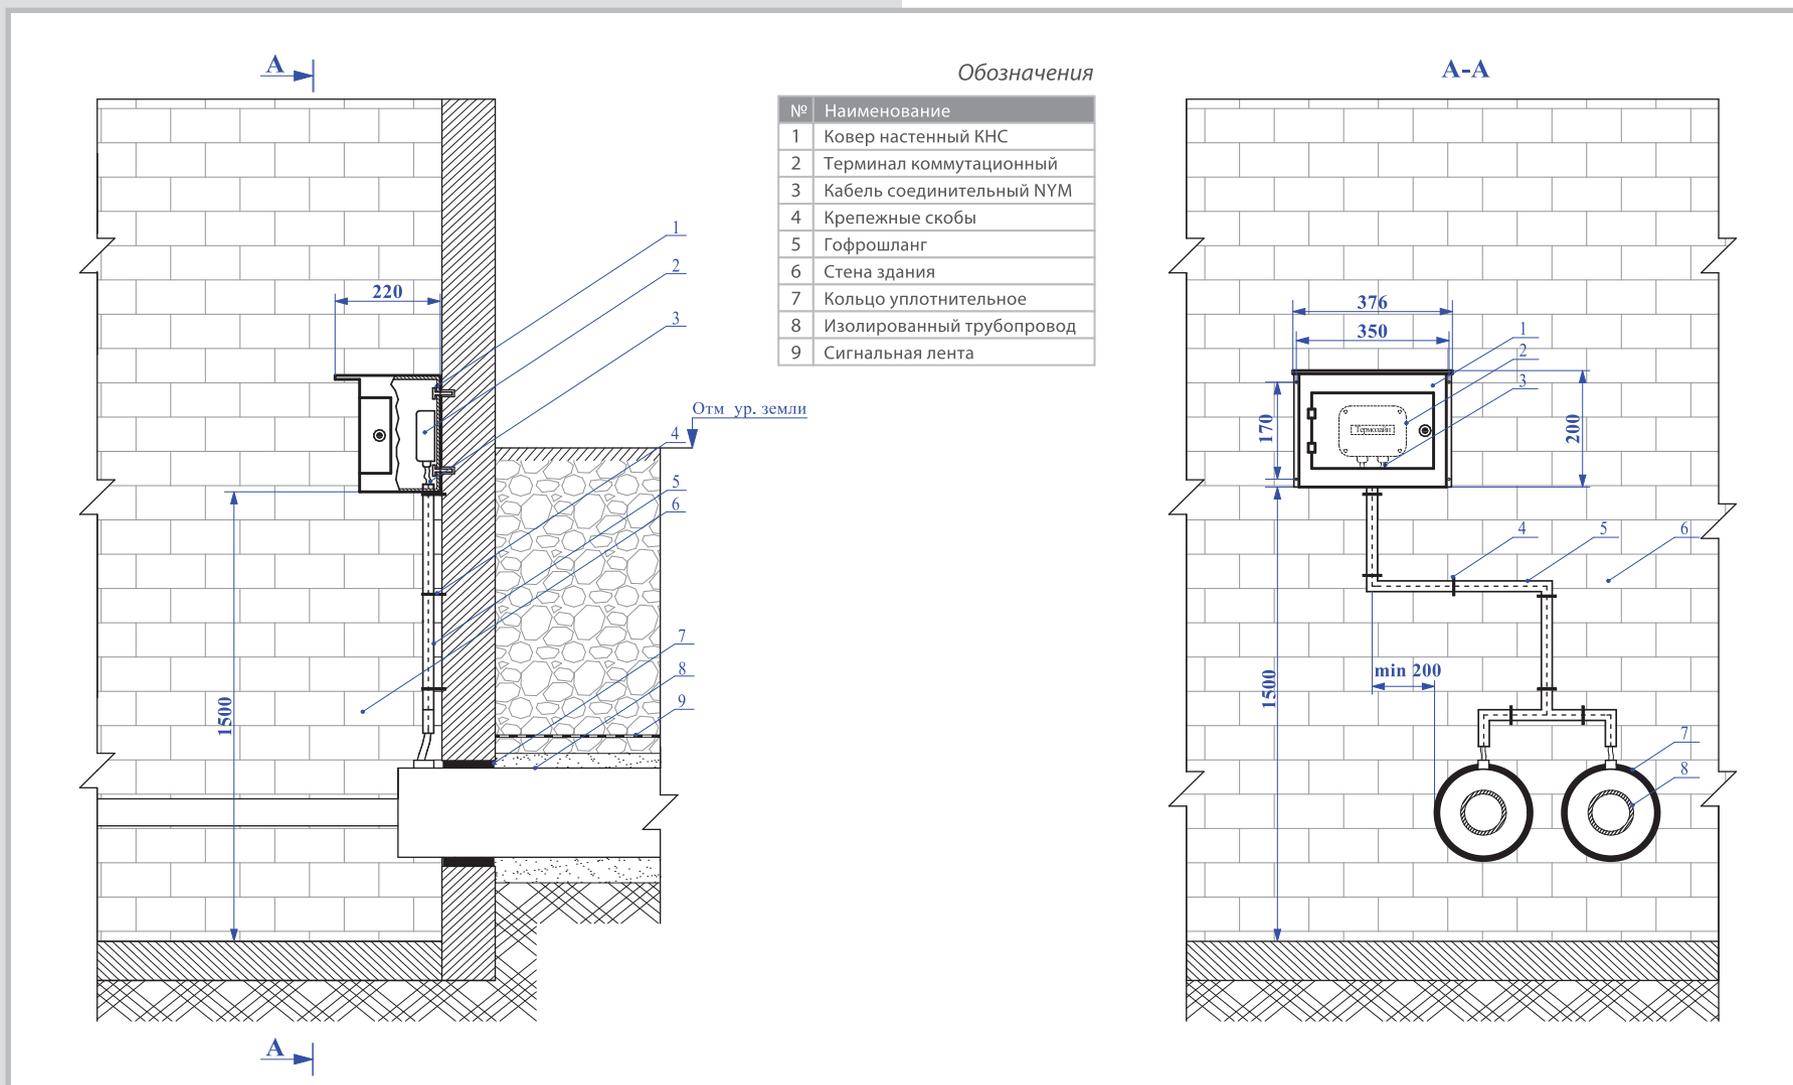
Монтажная схема установки ковра настенного КНС в подвале здания
